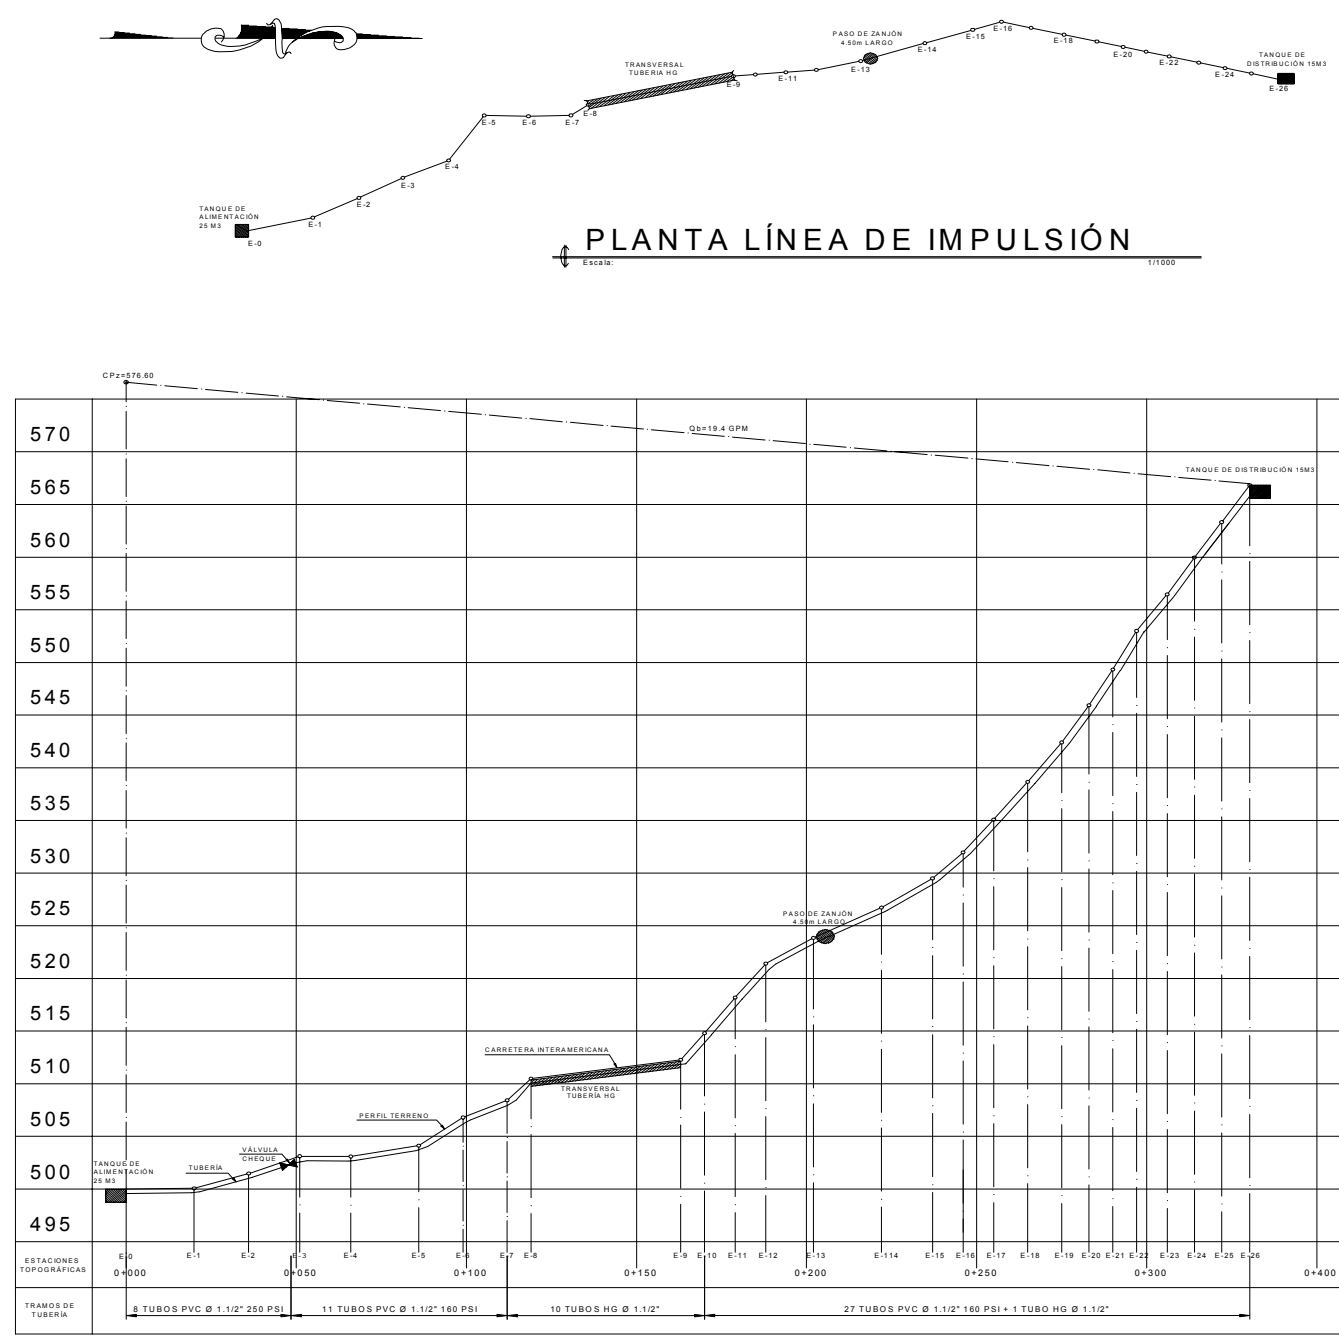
Plano de planta y perfil línea de conducción por bombeo
